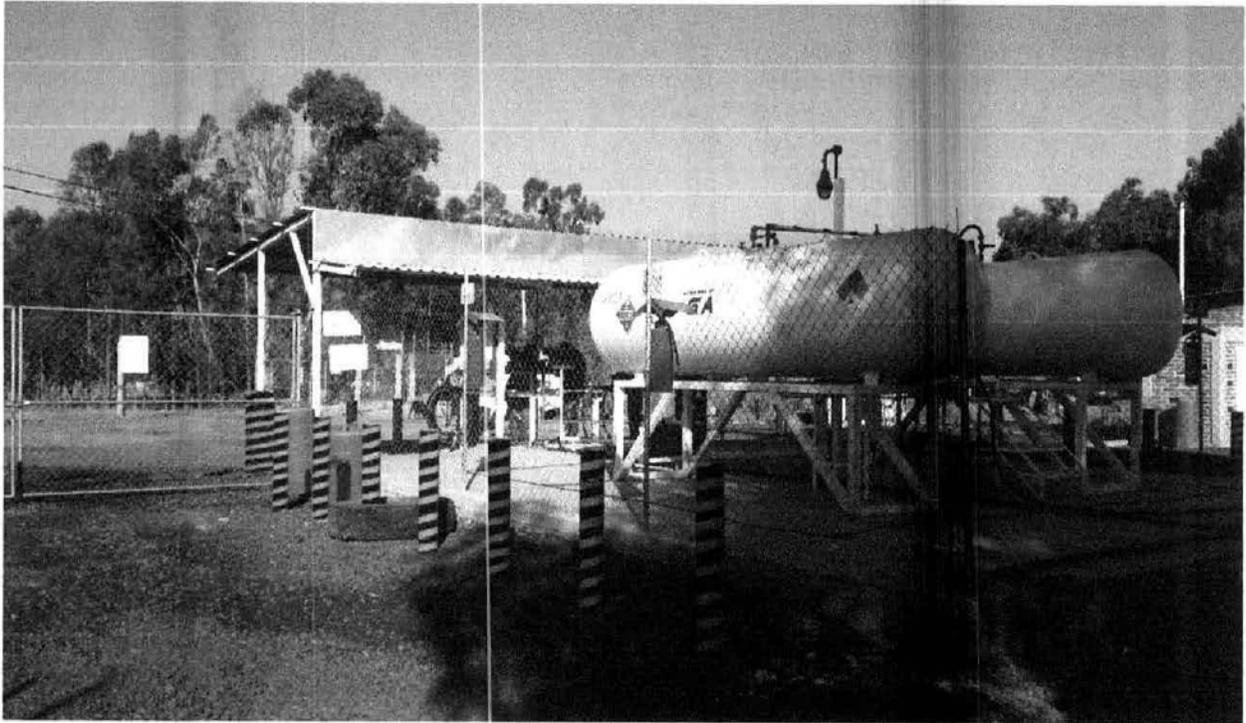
Tanques de almacenamiento sobre bases de concreto armado y soporte metálicos.
